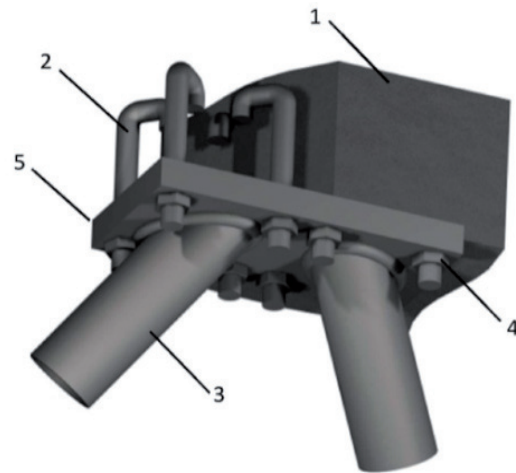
Кріплення розкосів до плити за допомогою анкерних болтів: 1 – сталезалізобетонна плита; 2 – анкерні болти; 3 – похилі стрижні; 4 – гайка; 5 – сталева закладна пластина
